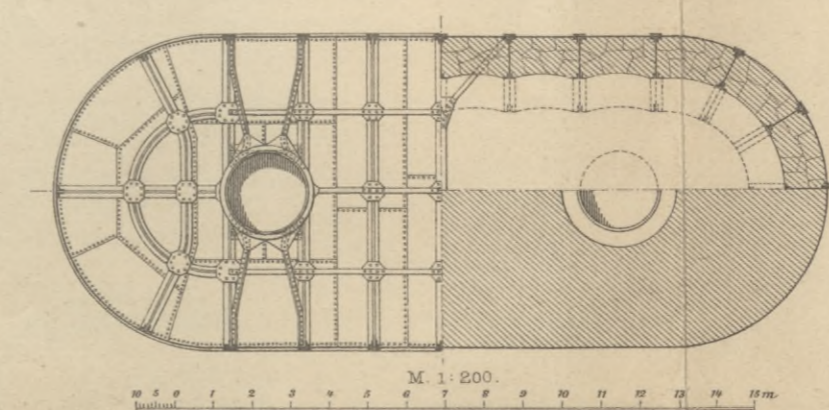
u. 15. Rheinbrücke bei Kehl. (1859).
